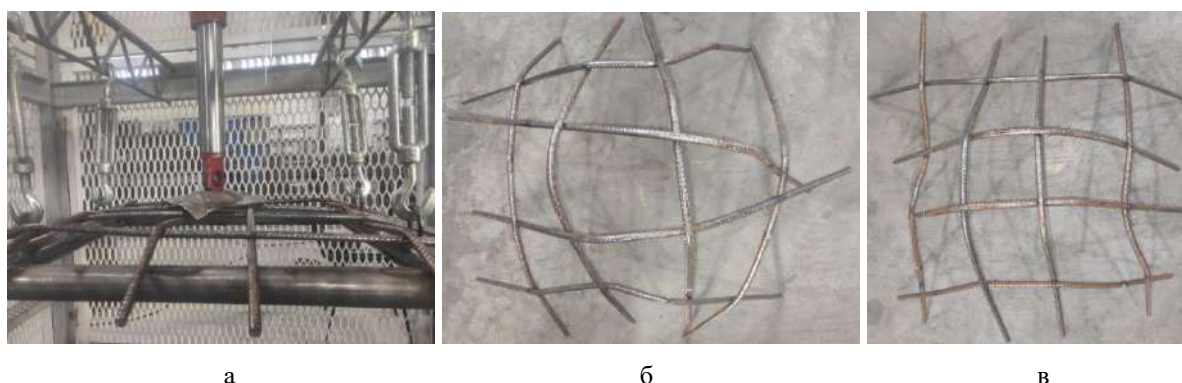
Испытание армокаркасов: а – общий вид стенда; б – вид армокаркаса без сварки в точках пересечения в центральной зоне; в – вид армокаркаса со сваркой во всех точках пересечения
